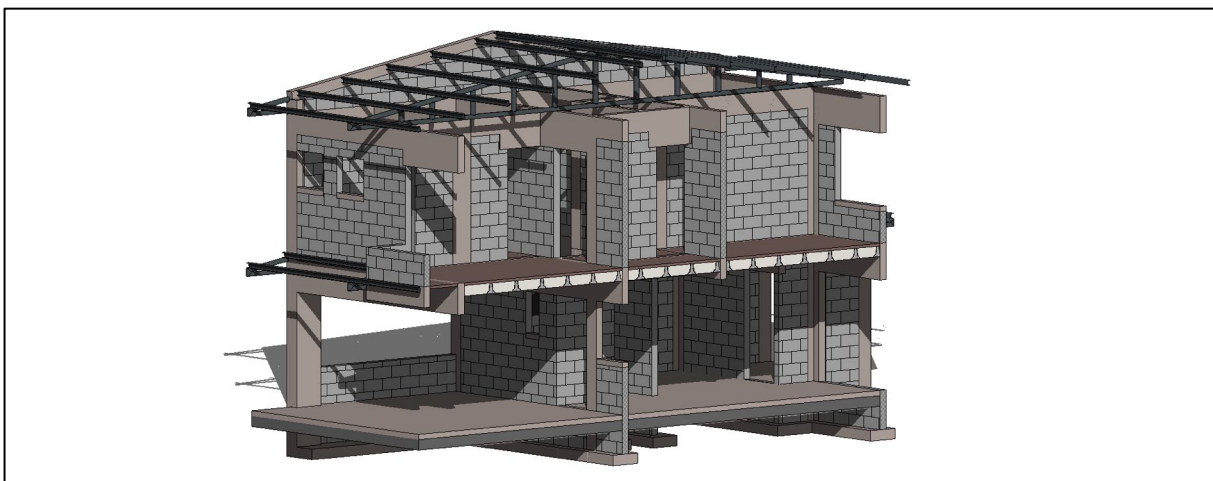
Vista en corte de detalles Modelo BIM Estructural del proyecto seleccionado
